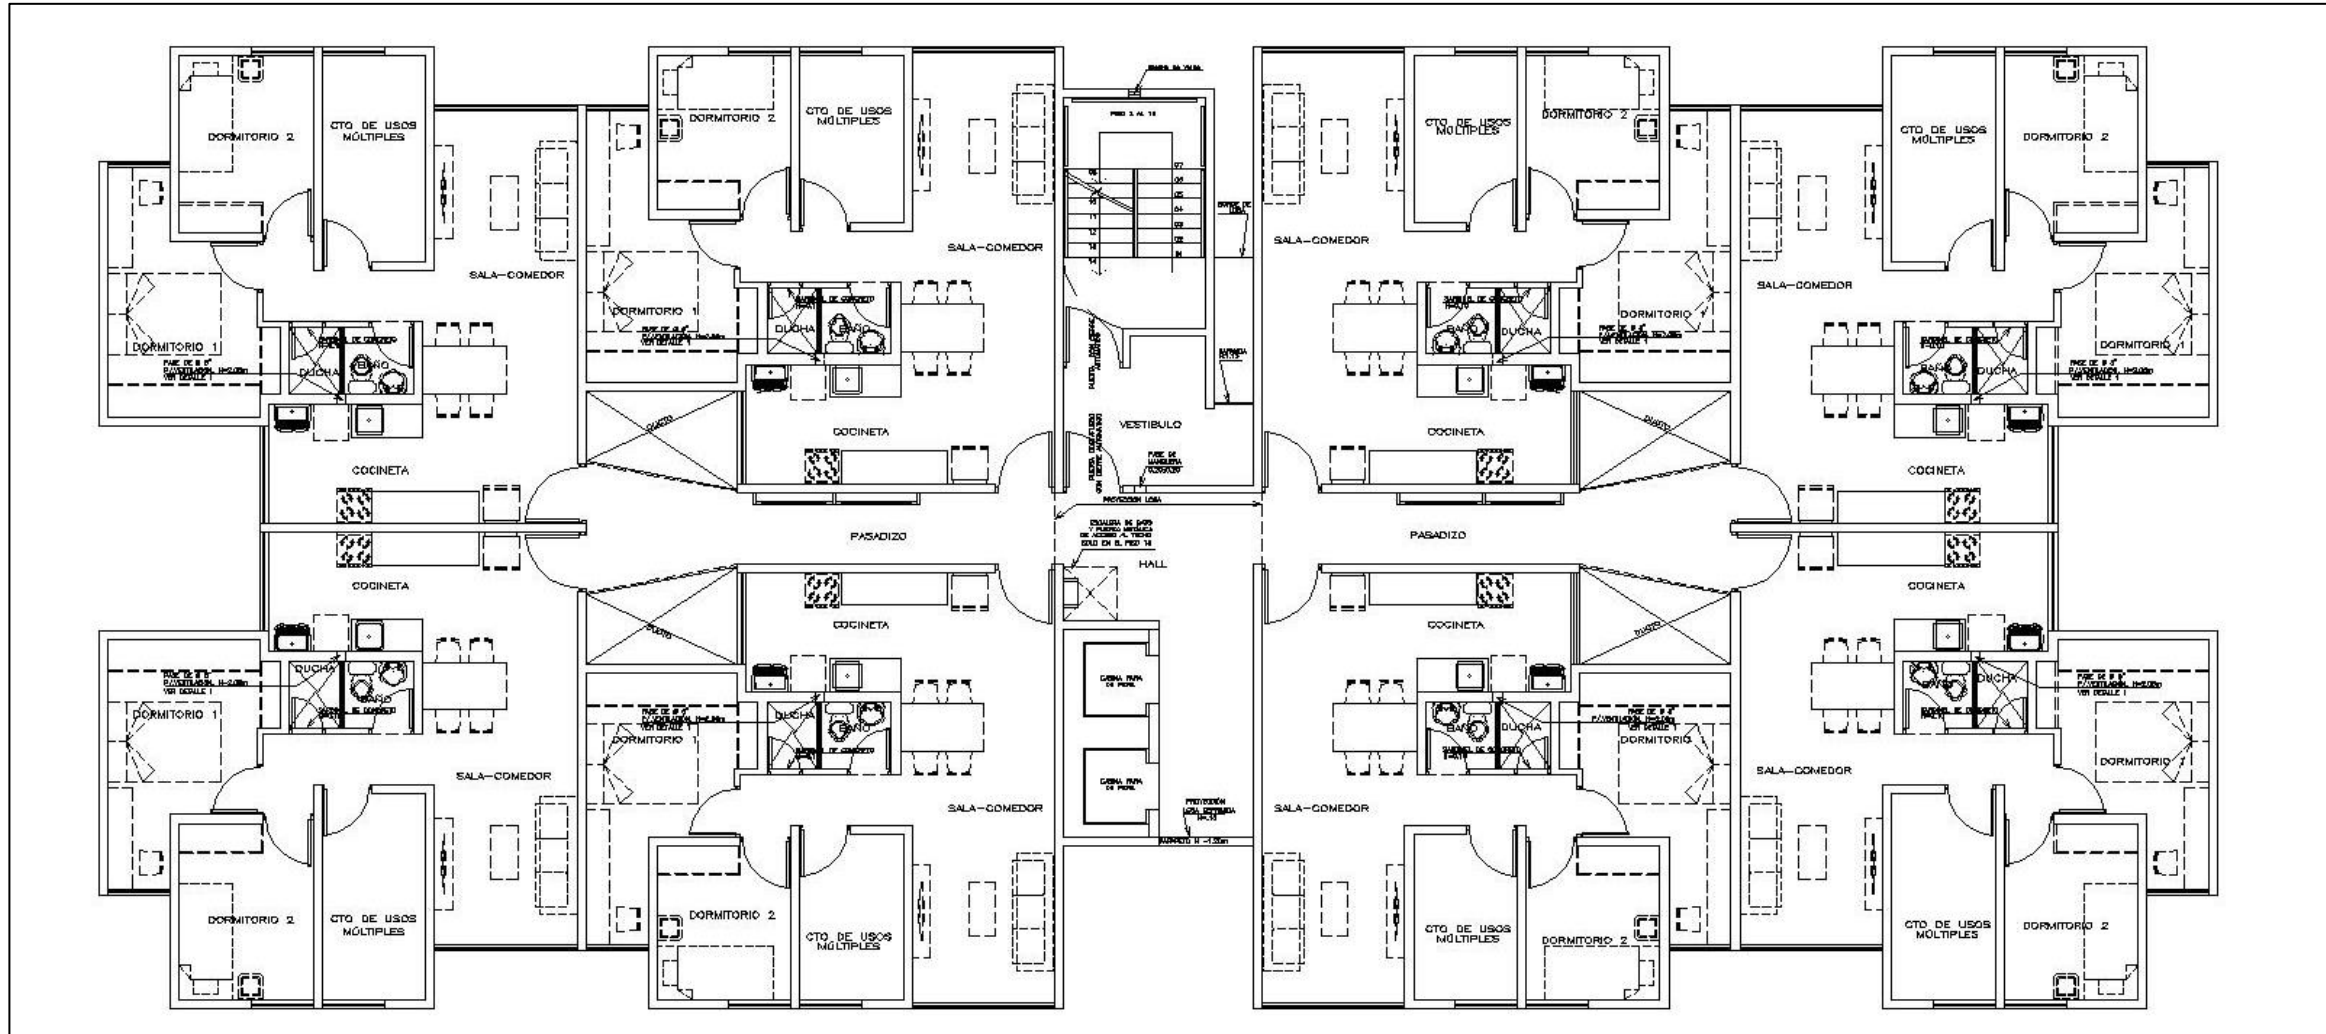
Arquitectura de Planta típica Fuente: proyecto 01
